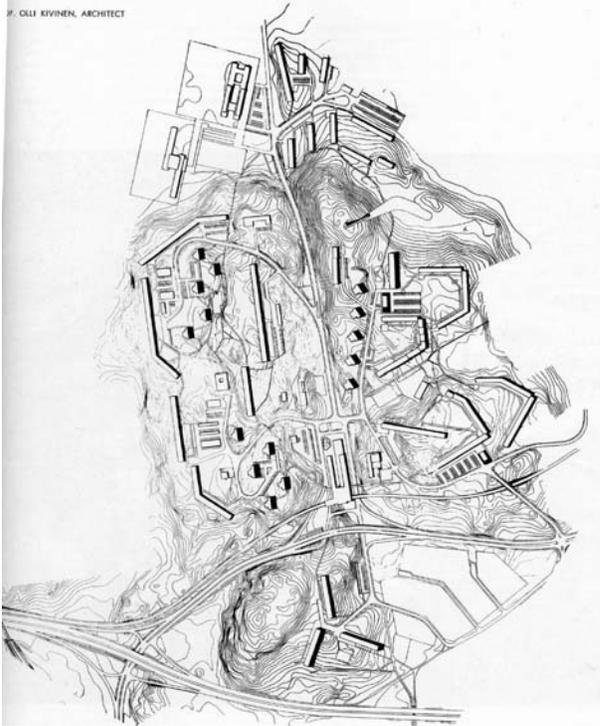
Oli Kivinen, Pihlajamaki, Plano
